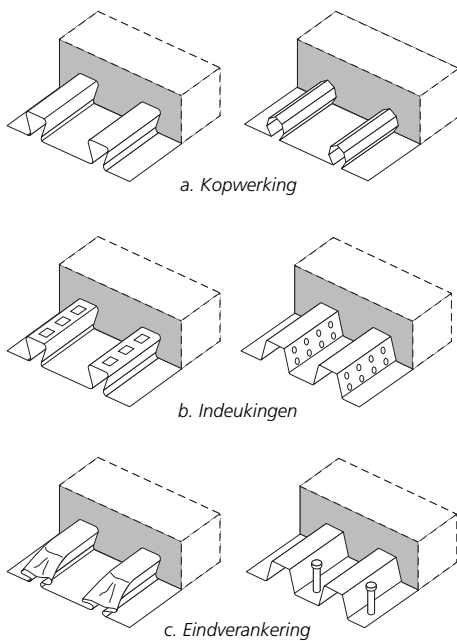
Enkele typen van geprofileerde platen voor staalplaat-betonvloeren
